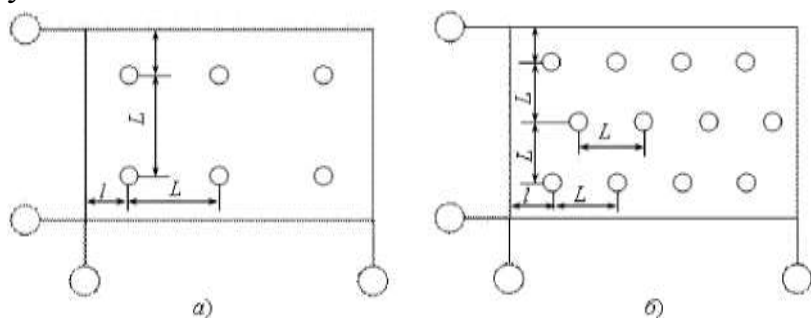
Размещение светильников на плане помещения: а) - по углам прямоугольника; б) - в шахматном порядке
